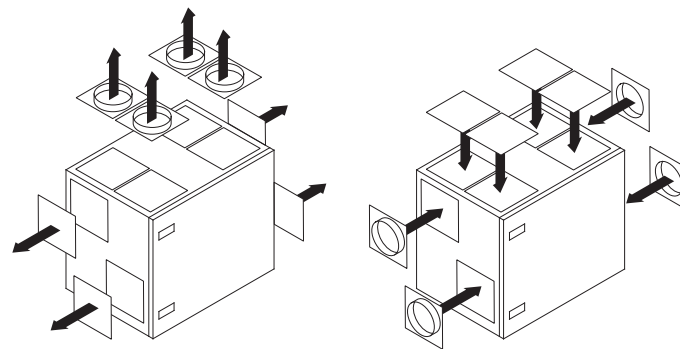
Перемещение соединений для воздуховодов в универсальных установках
